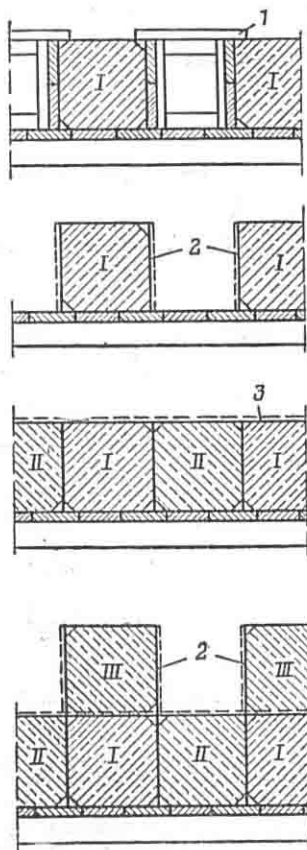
Порядок бетонирования железобетонных свай при размещении их без промежуточных нескольких ярусами:
